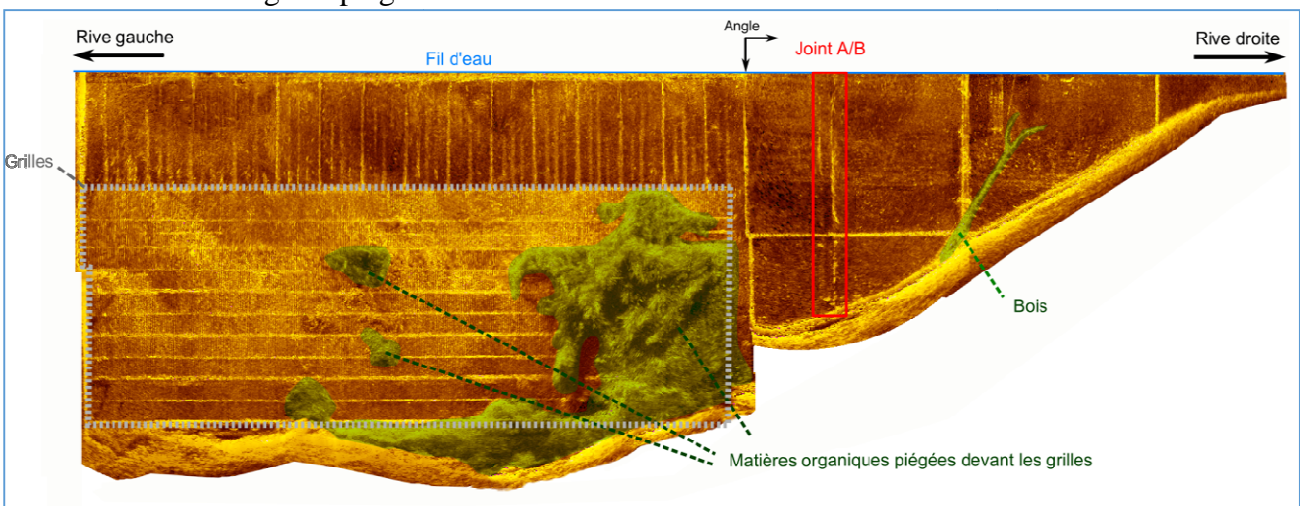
Vision 2D d'un plan de grilles d'usine et de son colmatage
